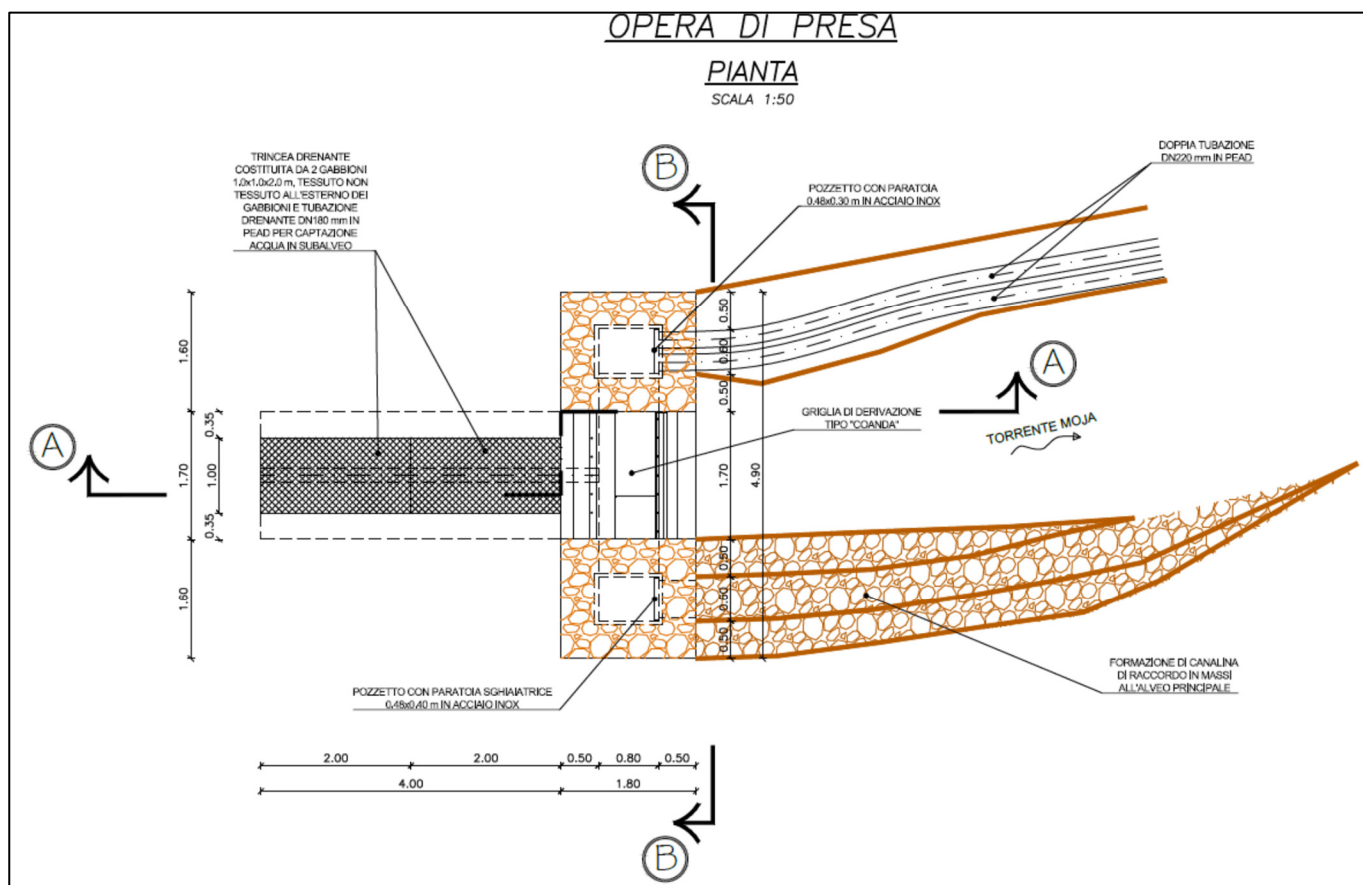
Planimetria di dettaglio dell'intervento in previsione (rio Moja)
